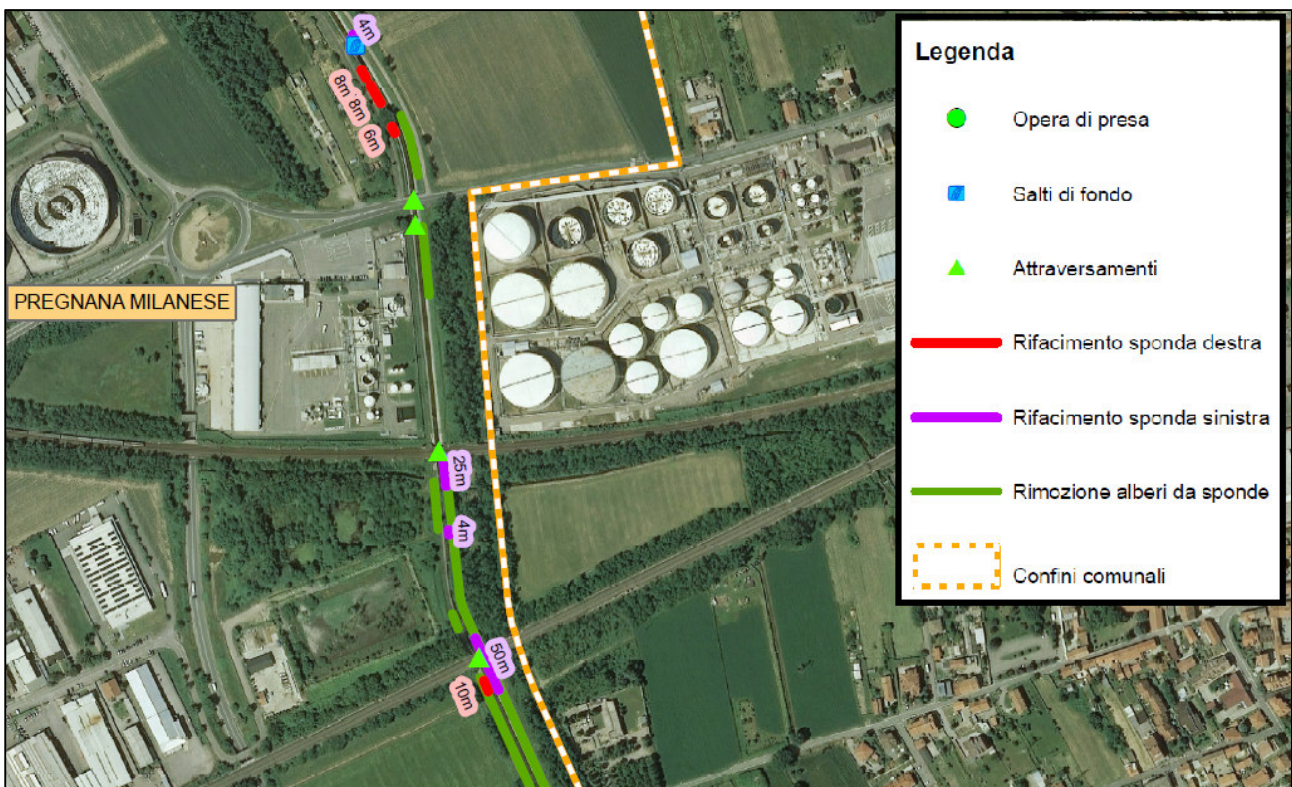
STRALCIO PLANIMETRIA DEGLI INTERVENTI SULLE SPONDE DEL RAMO OLONA (ELABORATO T.2.2)
